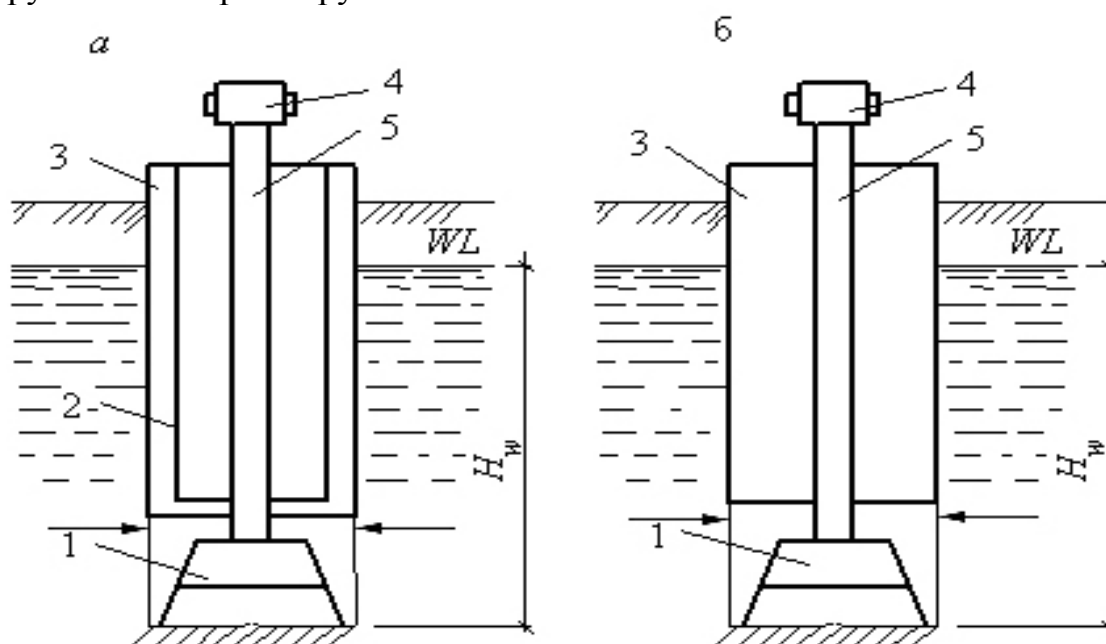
Схема устройства фундаментов глубокого заложения методом кессона: а – для заглубленного помещения; б – для глубокого фундамента; 1 – кессонная камера; 2 – гидроизоляция; 3 – надкессонное строение; 4 – шлюзовой аппарат; 5 – шахтная труба
